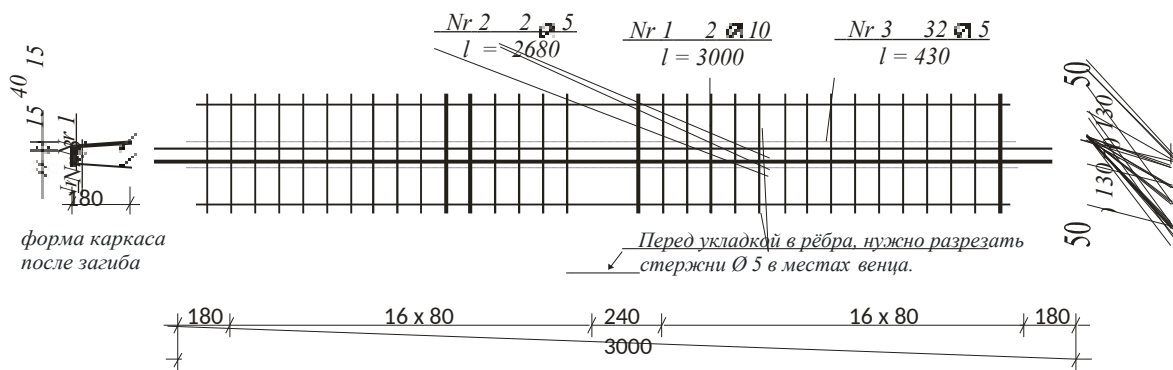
Дополнительный арматурный каркас, используемый в зоне опоры балок перекрытия «TERIVA NOVA» на стену, находящиеся на одном уровне.
